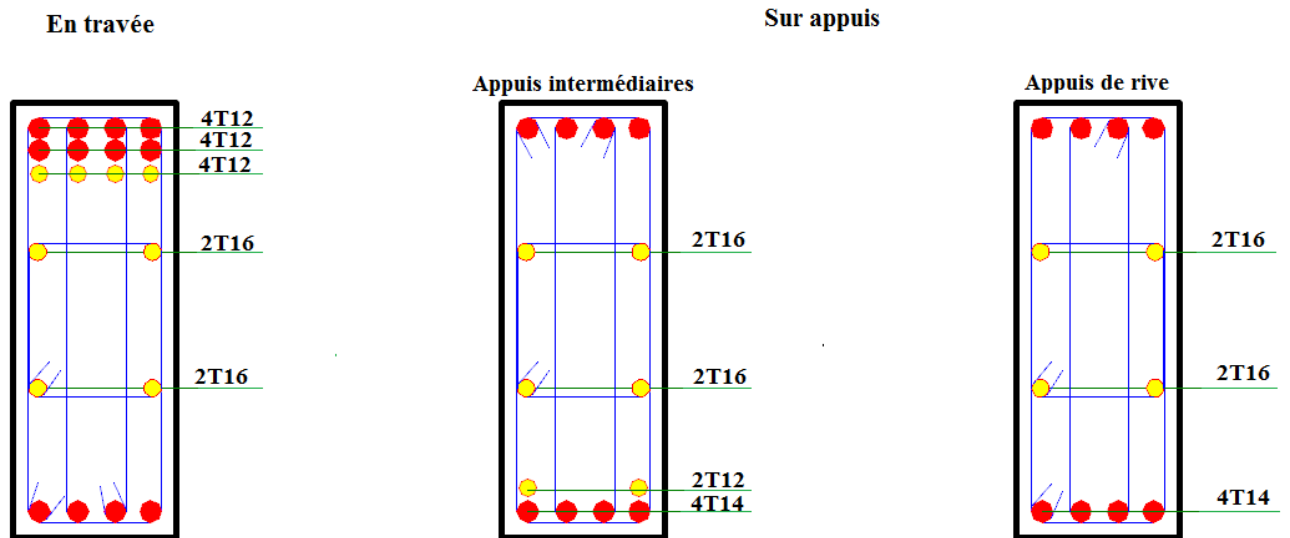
Ferrailage de la poutre de libage (sens transversal)
